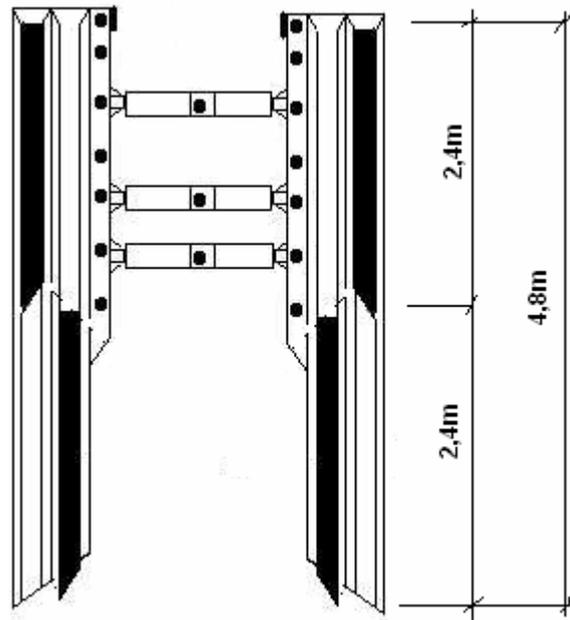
Vista Frontal Entibaciones Metálicas, Sistema Doble Corredera
